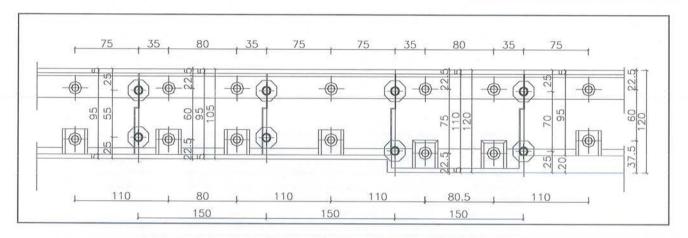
Stralcio Pianta fondazioni basamento prefabbricato
